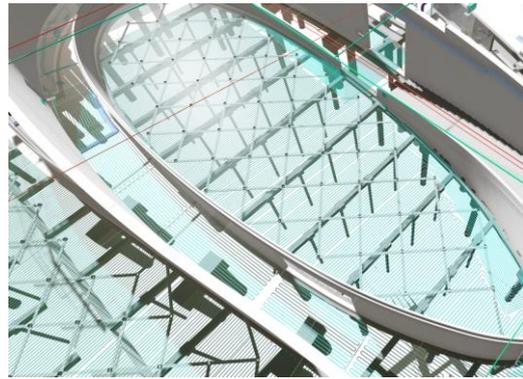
Detalhe do Modelo BIM de Estruturas e Arquitetura.
